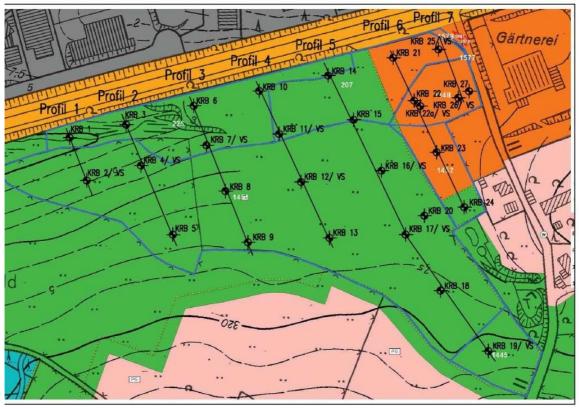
Lageplan Untersuchungsgebiet "Dohrmann-Fläche"
